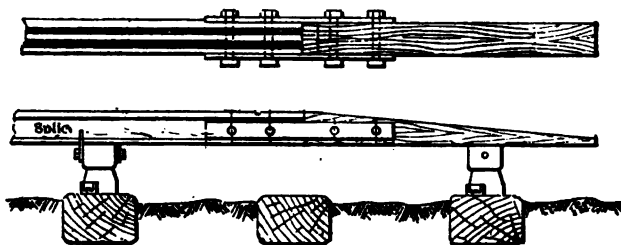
Extrémité de 3^e rail avec plan incliné en bois.
